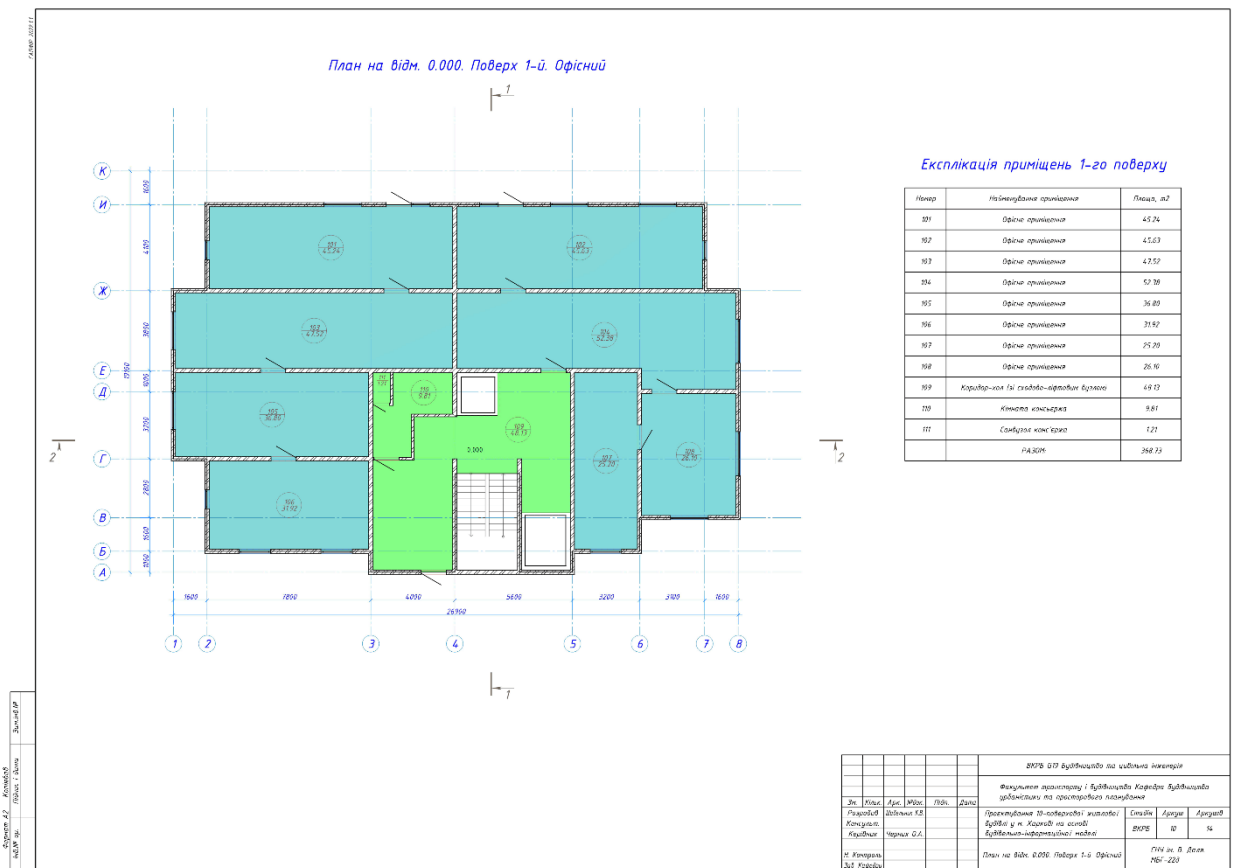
План на відм. 0.000. Поверх 1-й. Офісний
